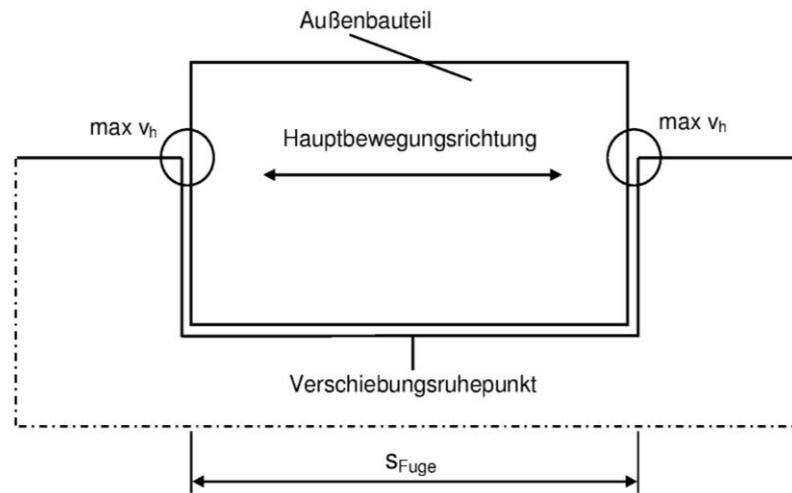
Einbausituation mit Lagerung an gegenüberliegenden Rändern
